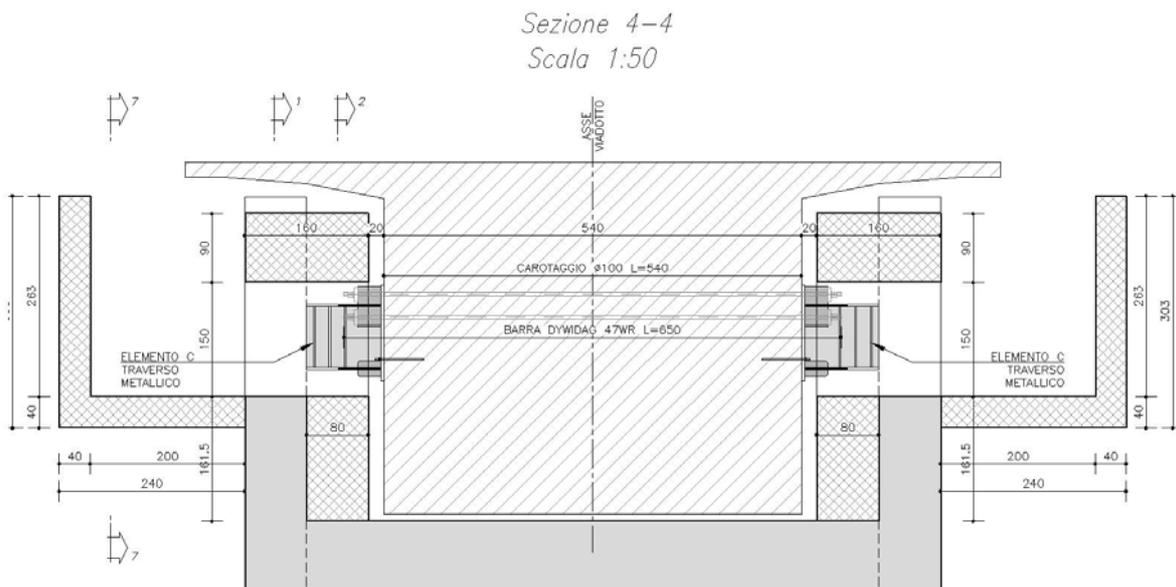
SP.3 - Sezione trasversale in asse appoggi (allineamento lato Bardonecchia)
